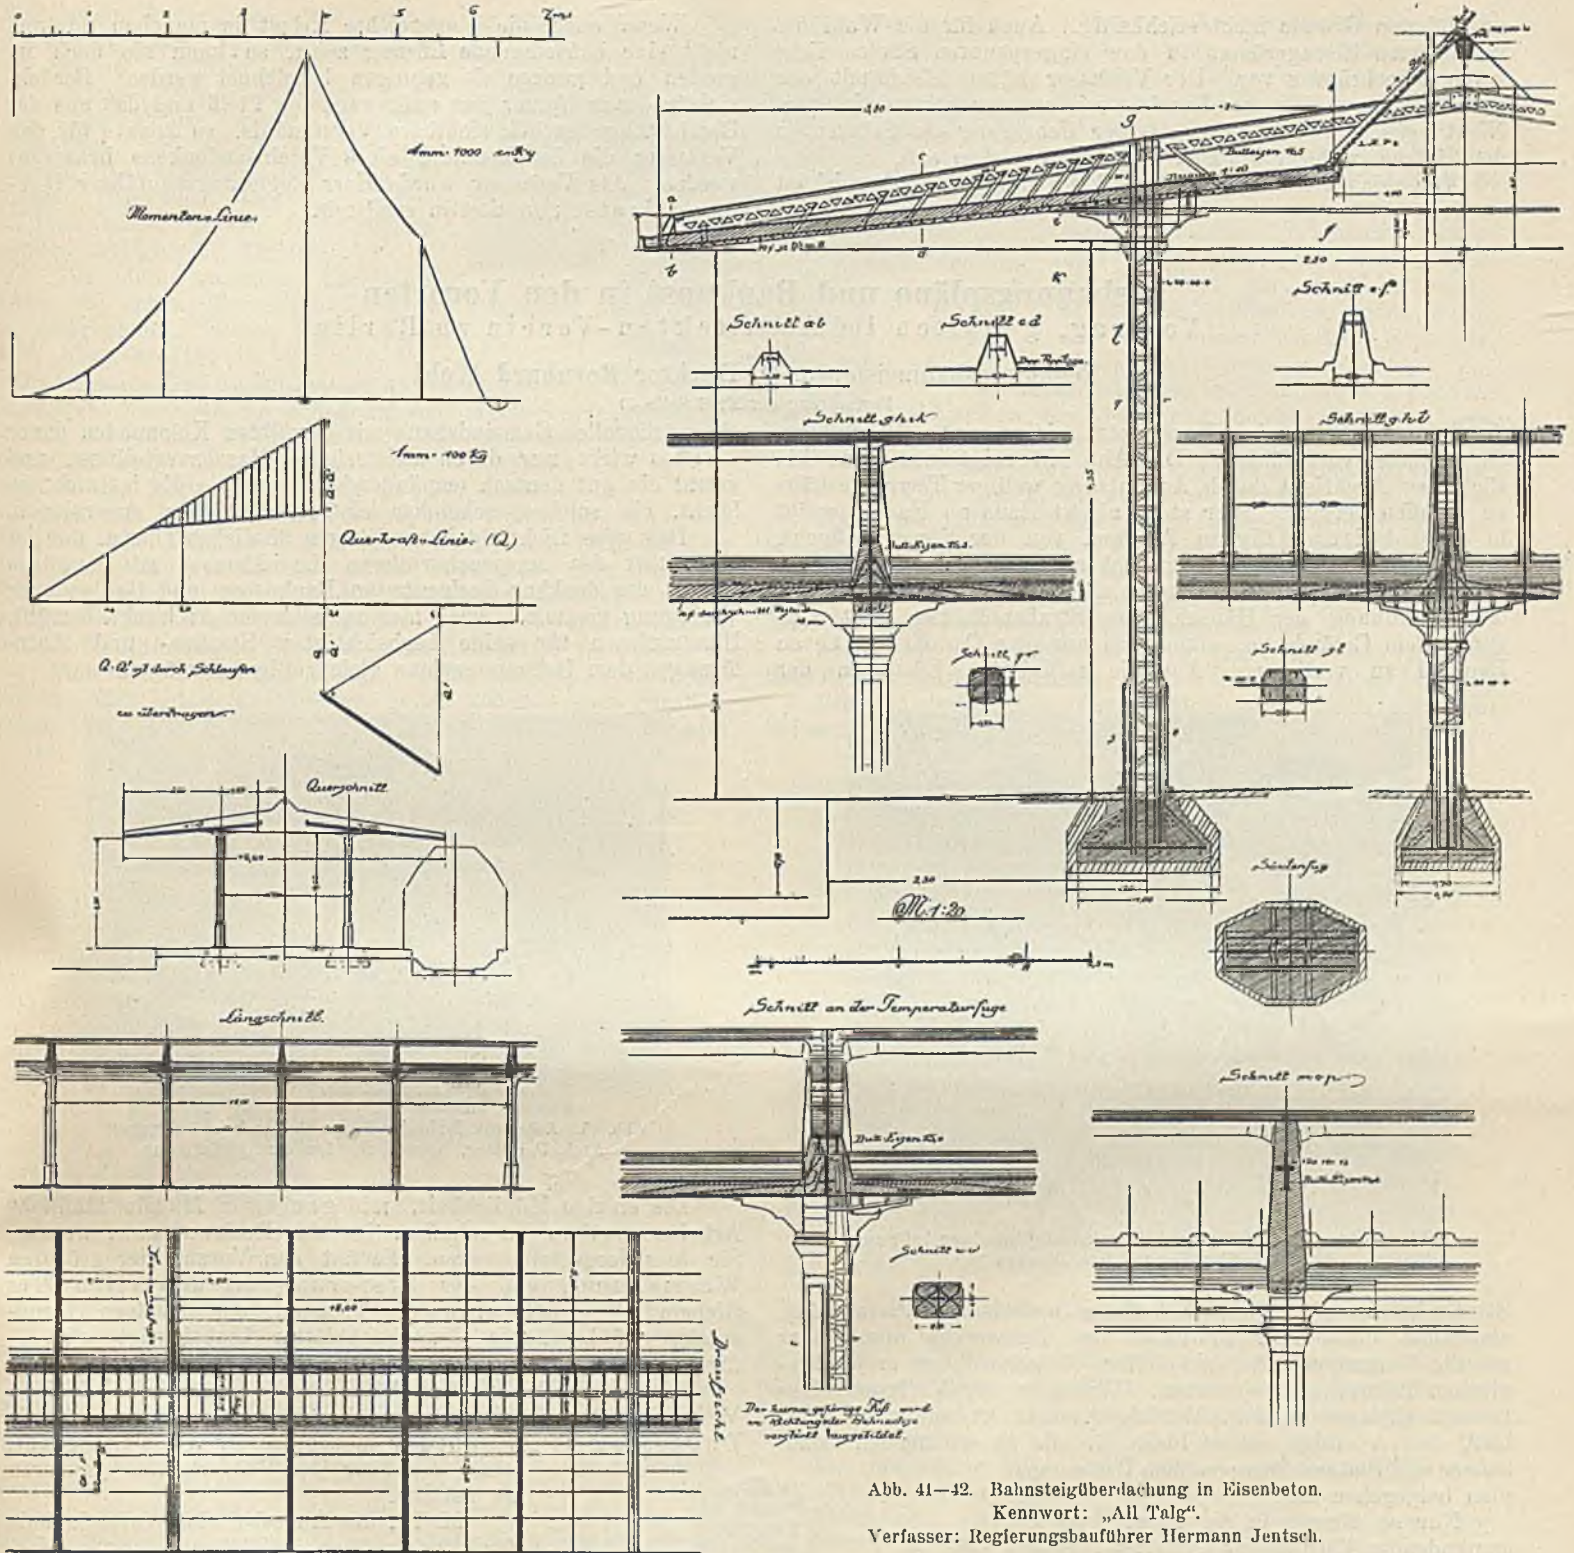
Bahnsteigüberdachung in Eisenbeton.
